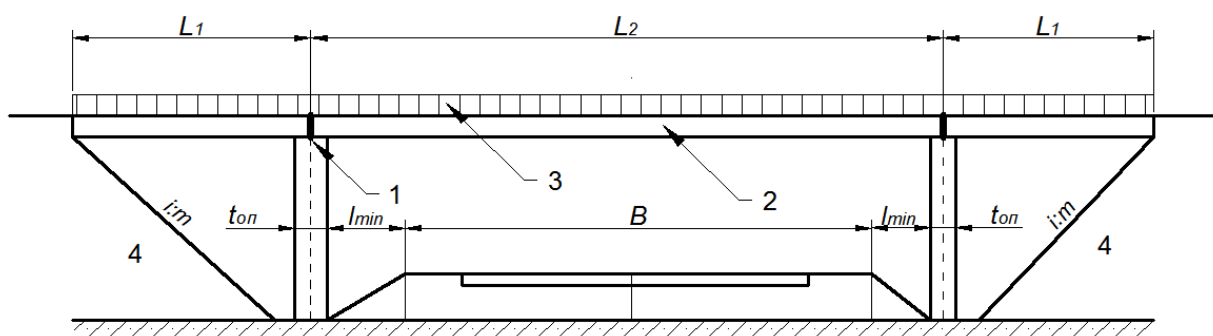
Схема трехпролетного балочного путепровода: 1 – опора; 2 – пролетное строение; 3 – перила; 4 – конус насыпи
